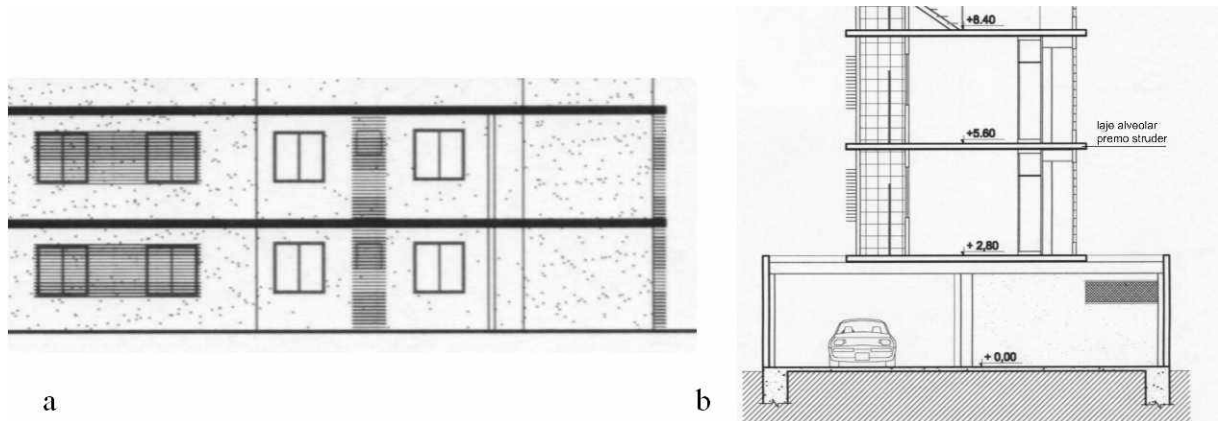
Detalhes do sistema construtivo e revestimentos. a) parte da fachada lateral esquerda, onde se vê a unificação de aberturas; b) parte de corte transversal, apresentando a estrutura.
